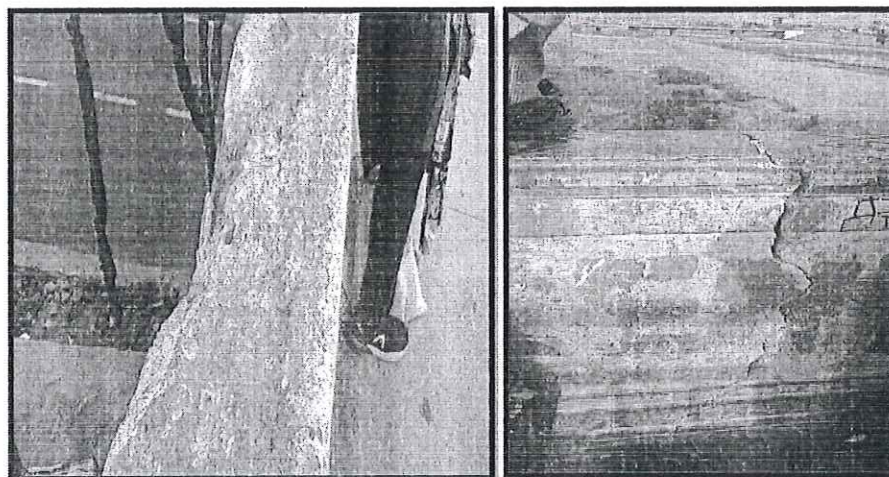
MURO TIPO 1 Y MURO PARA DEMOLER
